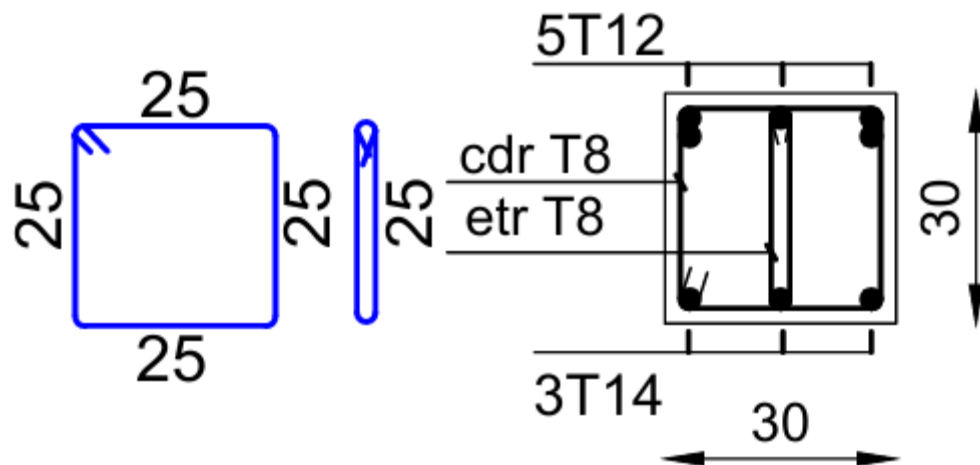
Schéma de ferrailage de poutre aux appuis.
